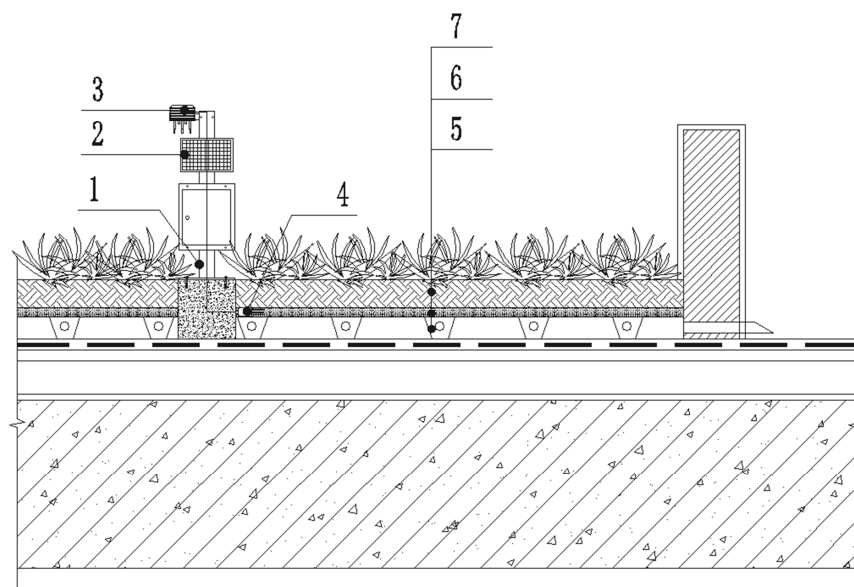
系统与绿色屋面结合应用构造示意图
